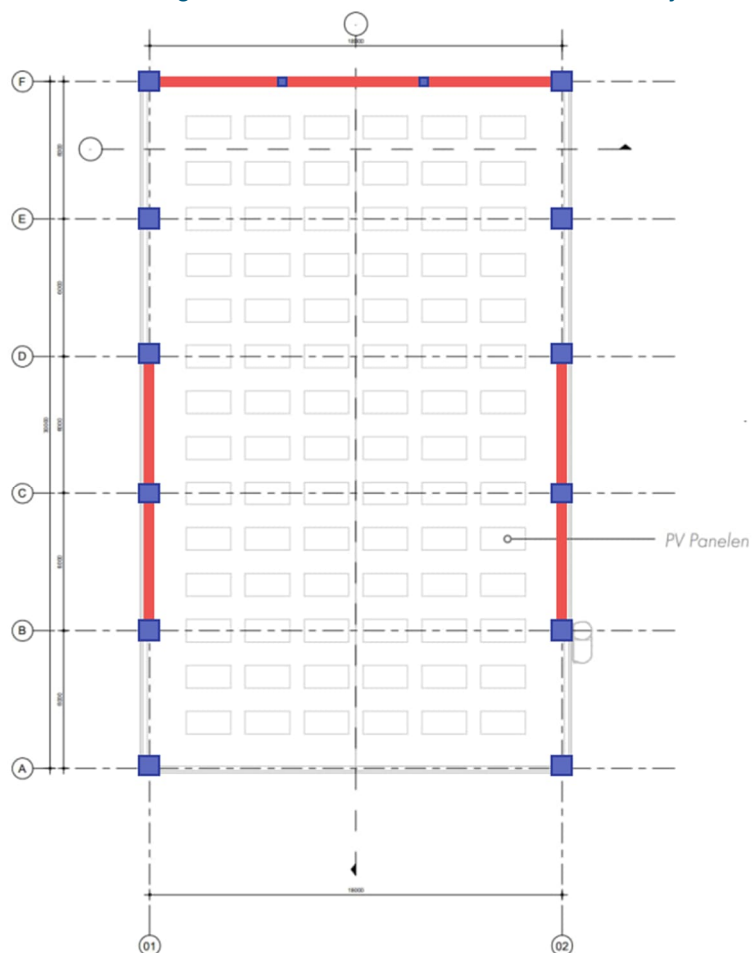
constructieprincipe dakvlak zoutloods
